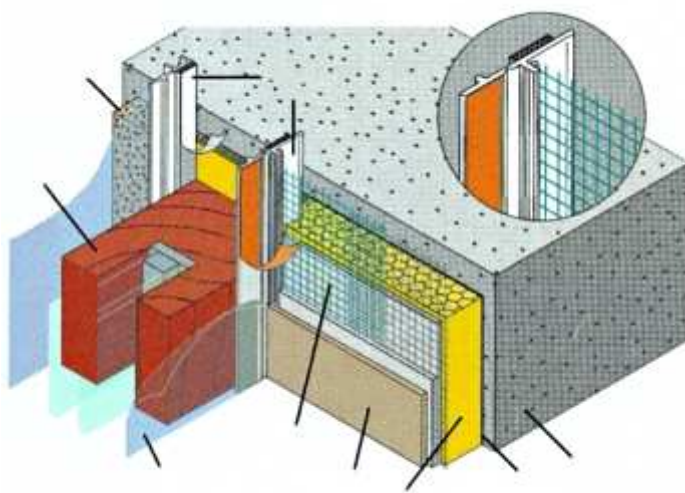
Detail - parapet - parapetní profil ETICS - alternativa
